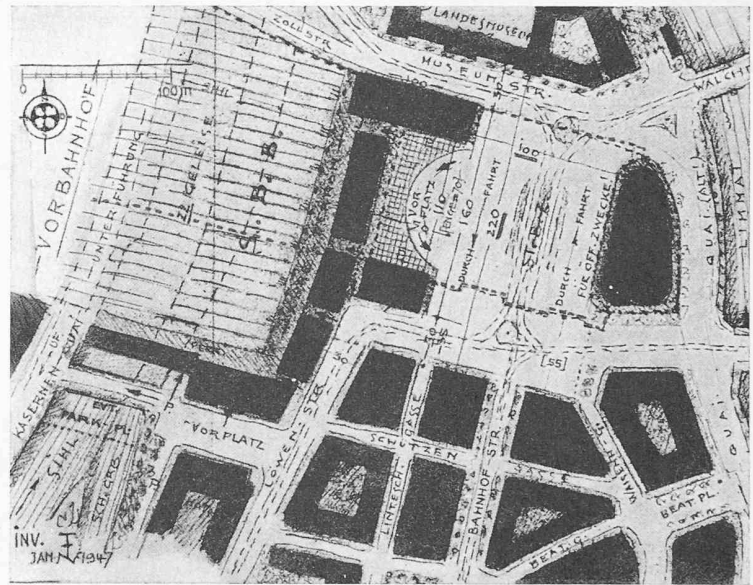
Skizze von Arch. F. W. FISSLER für die Gestaltung des Bahnhofplatzes. Masstab 1:5000
